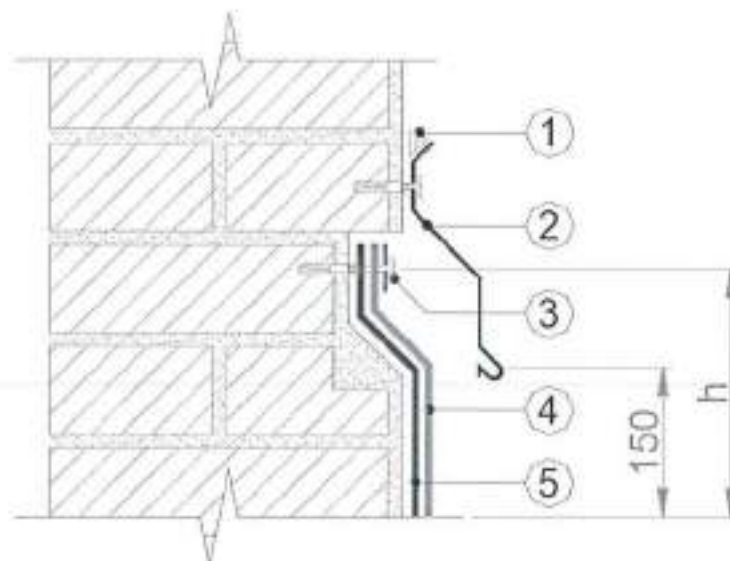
Схема механического закрепление края кровельного ковра к стене
